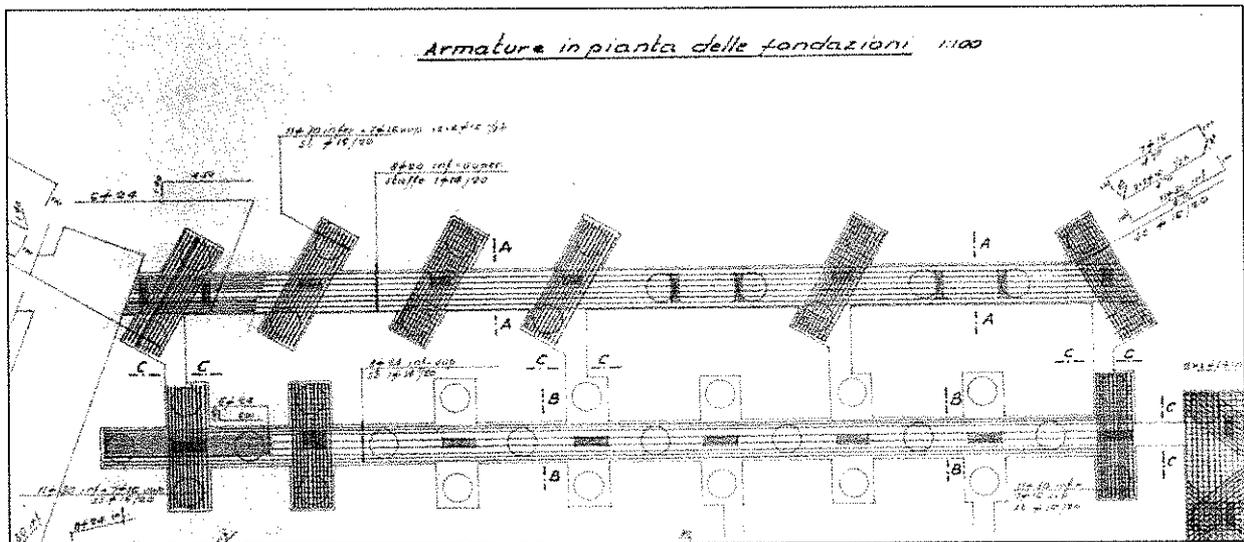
Progetto originario – Tav. 18 – Stralcio - Particolare armatura fondazioni pilastri della spina centrale
